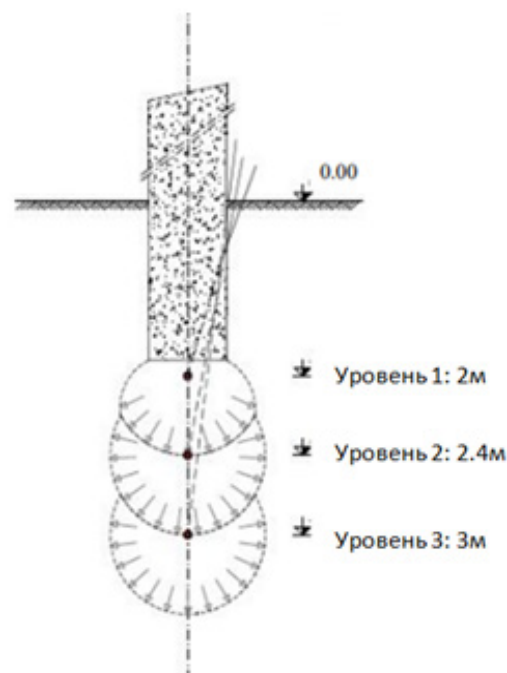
Уровни обработки вдоль фундаментных стен здания
